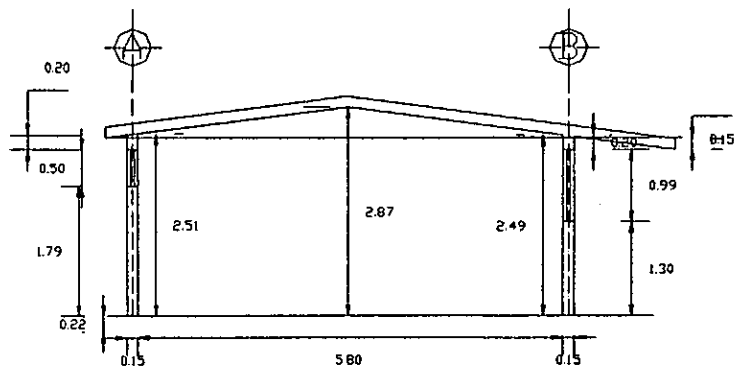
Planta y alzado arquitectónico de aula tipo en plantel Mariano Azuela
